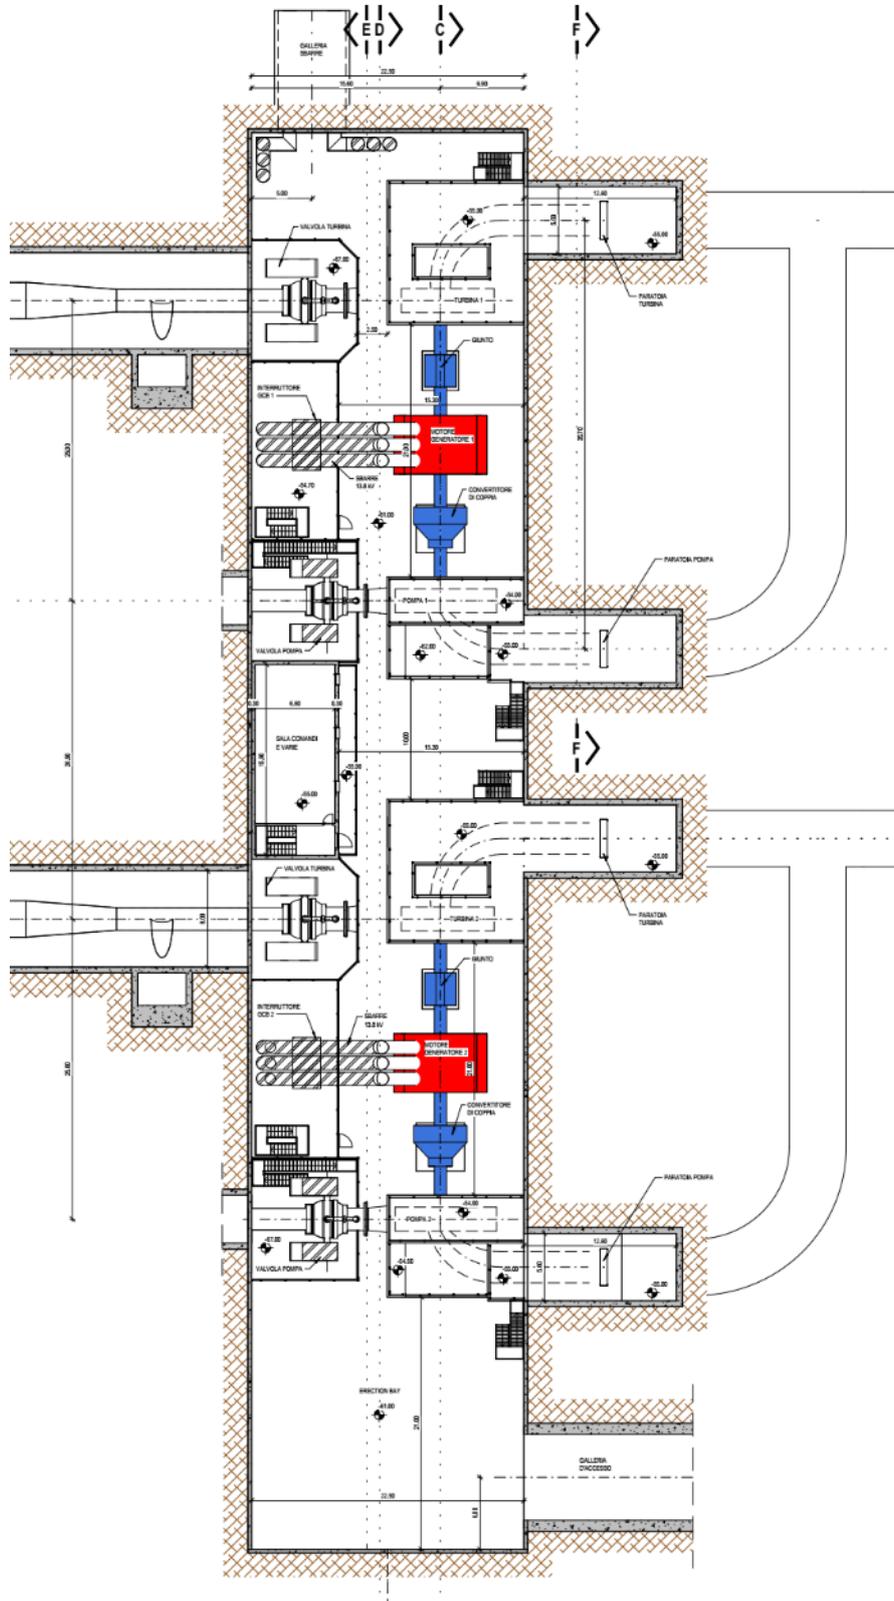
Pianta della centrale – dettaglio della sala macchine
